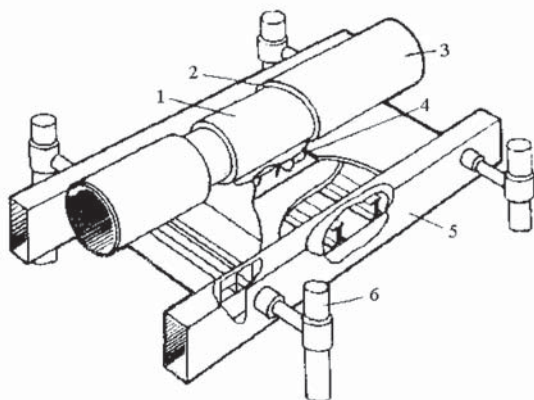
Общий вид опорного устройства «скользящий анкер»:
